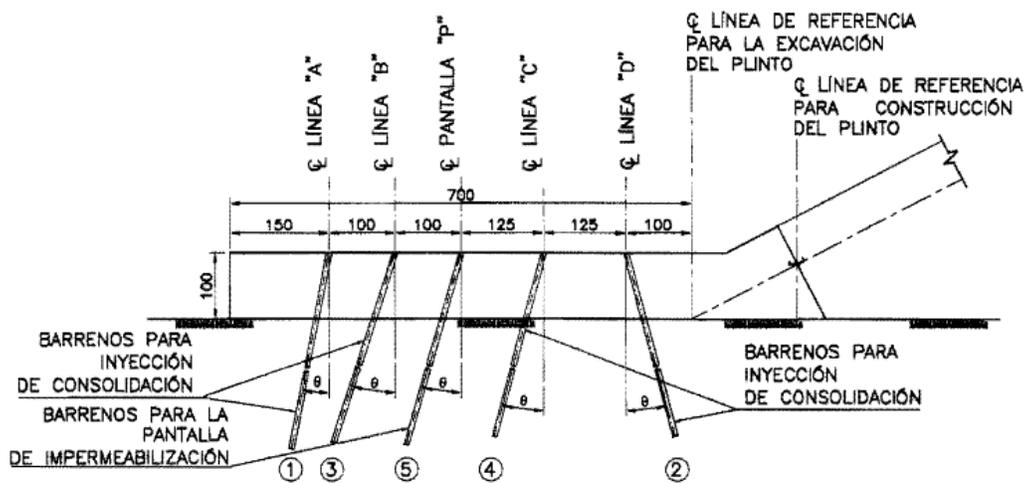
Distribución de los barrenos en el plinto en la sección del lecho del río
